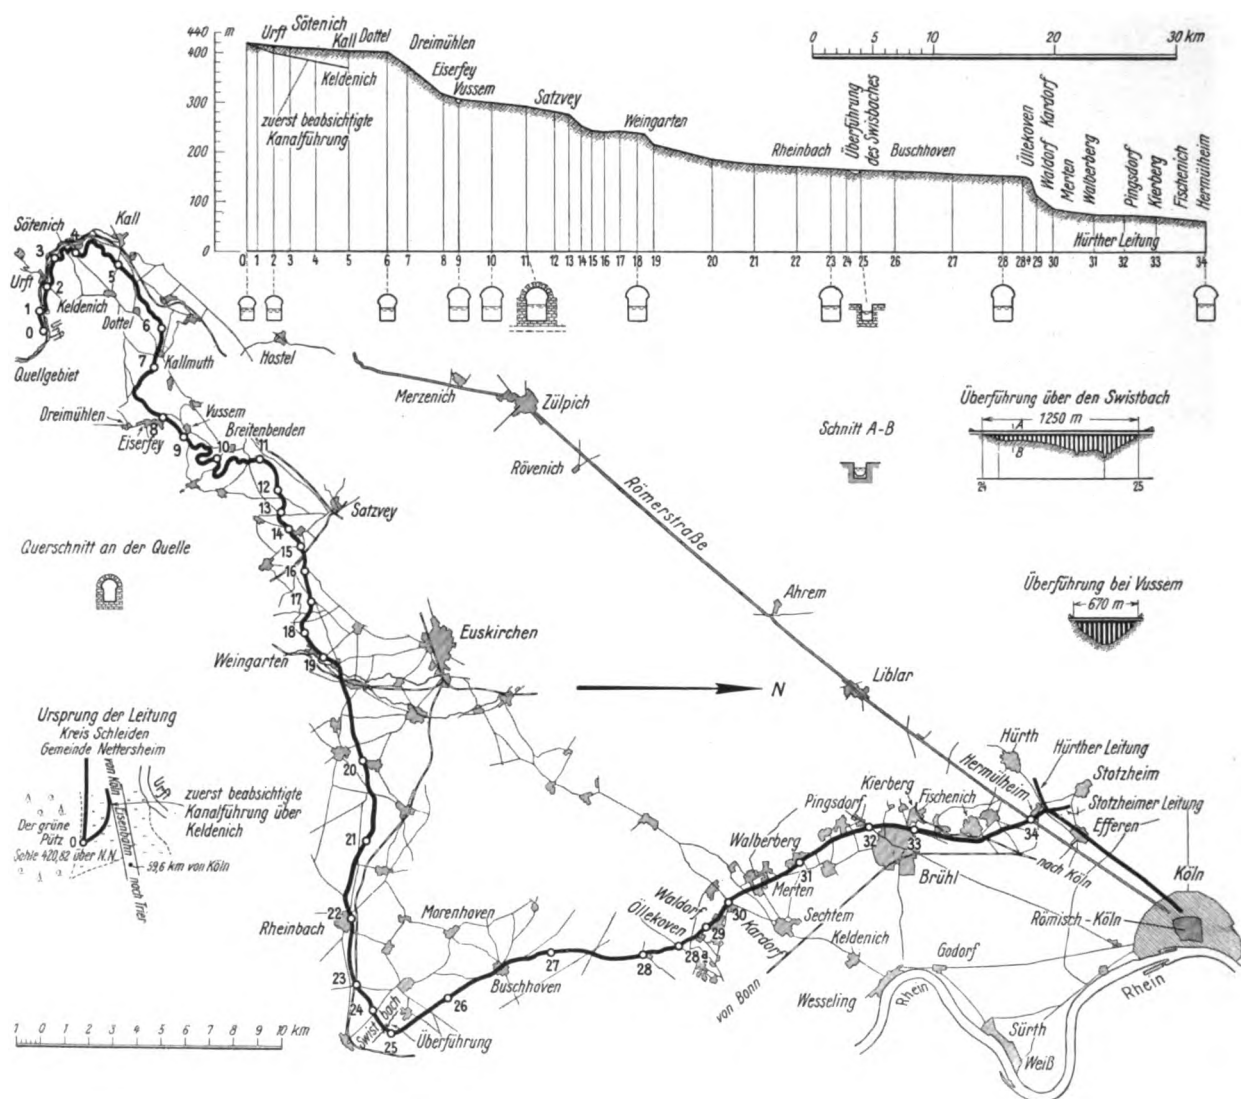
Lageplan der römischen Wasserleitung bei Köln
